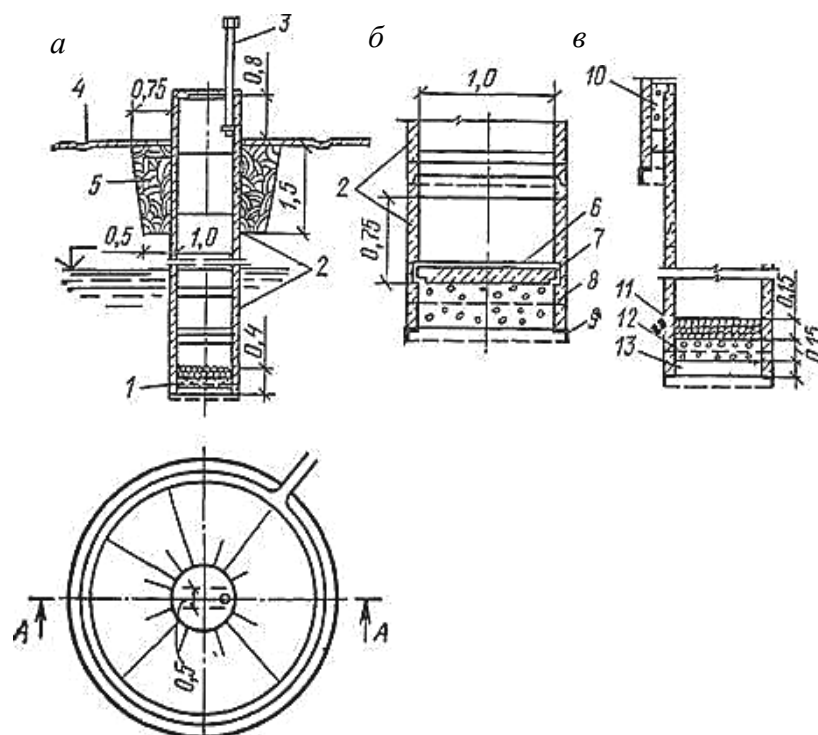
Конструкция шахтного колодца из сборных железобетонных колец:
